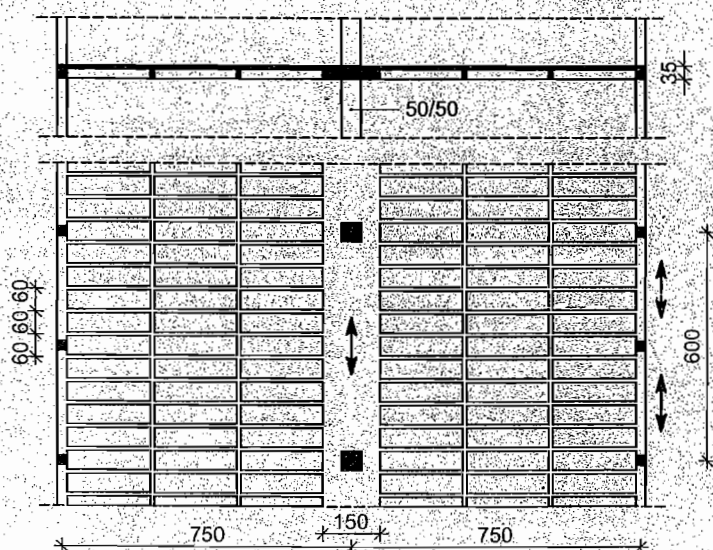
Čelična konstrukcija zgrade s punom betonskom pločom stropa
